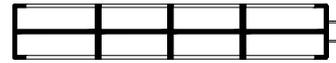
Planimetría del Total Furniting Unit. Elaboración propia
